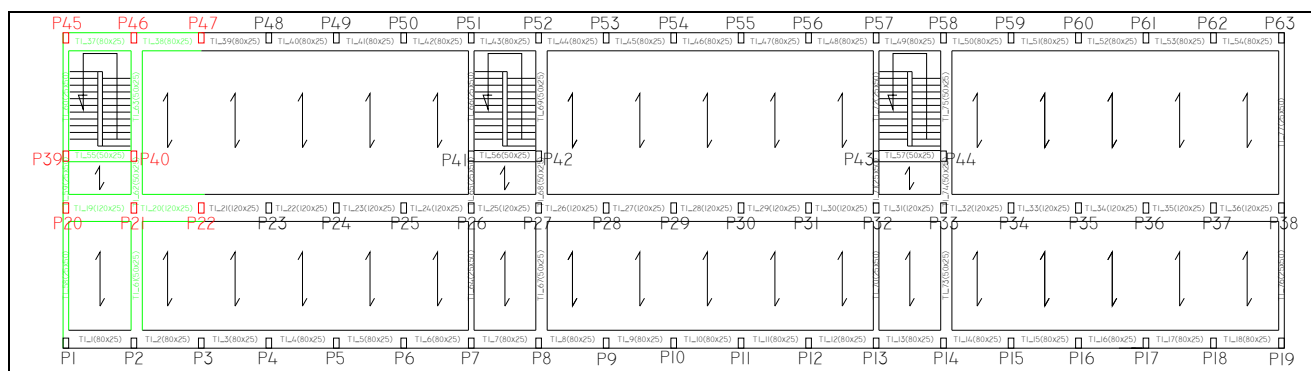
Elementi travi (in verde) e pilastri (in rosso) da utilizzare per il conteggio degli elementi da indagare
